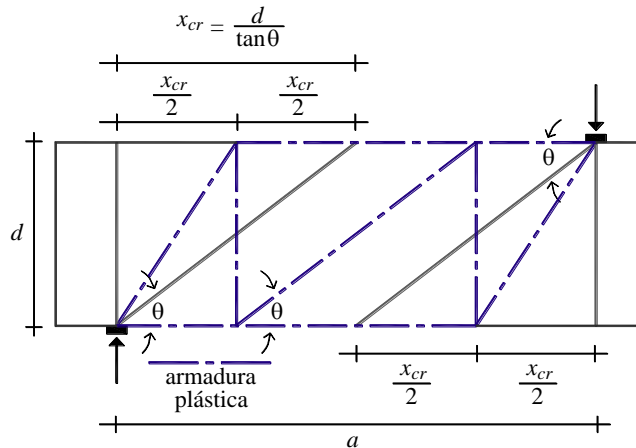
Modelo de armadura plástica para una trabe de sección constante
